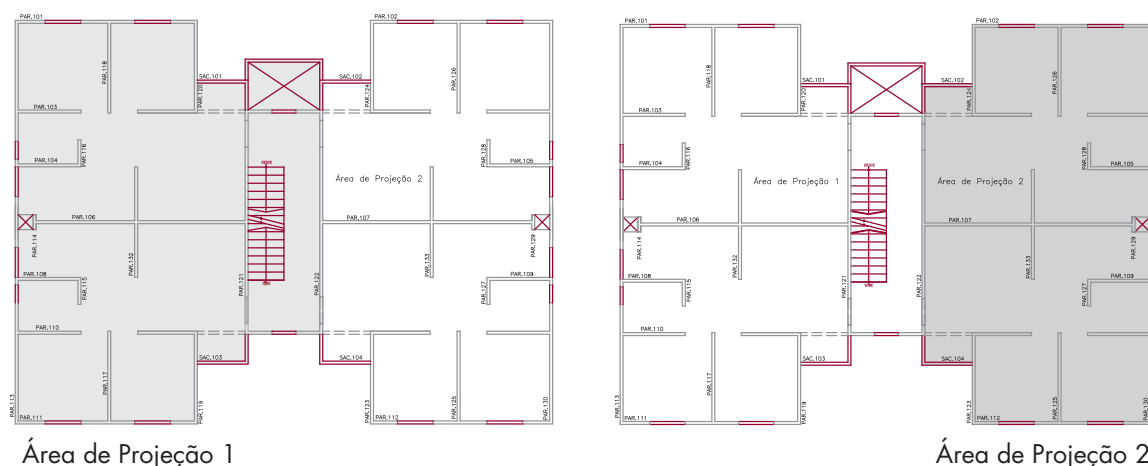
projeto do pavimento tipo com as duas etapas de concretagem
